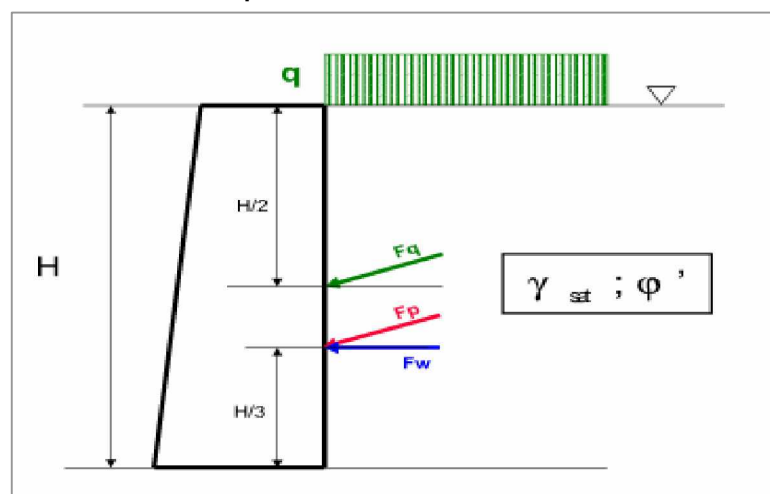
Bilan de forces agissant sur un mur de soutènement.
